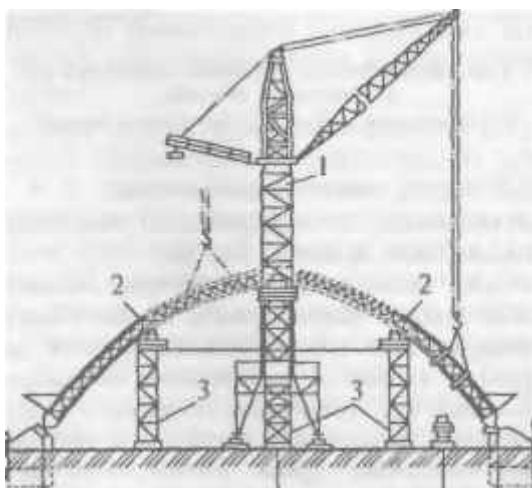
Монтаж арочного покрытия с использованием передвижных подмостей: 1 - башенный кран; 2 - монтажные стыки арки; 3 - передвижные монтажные подмости с домкратами
